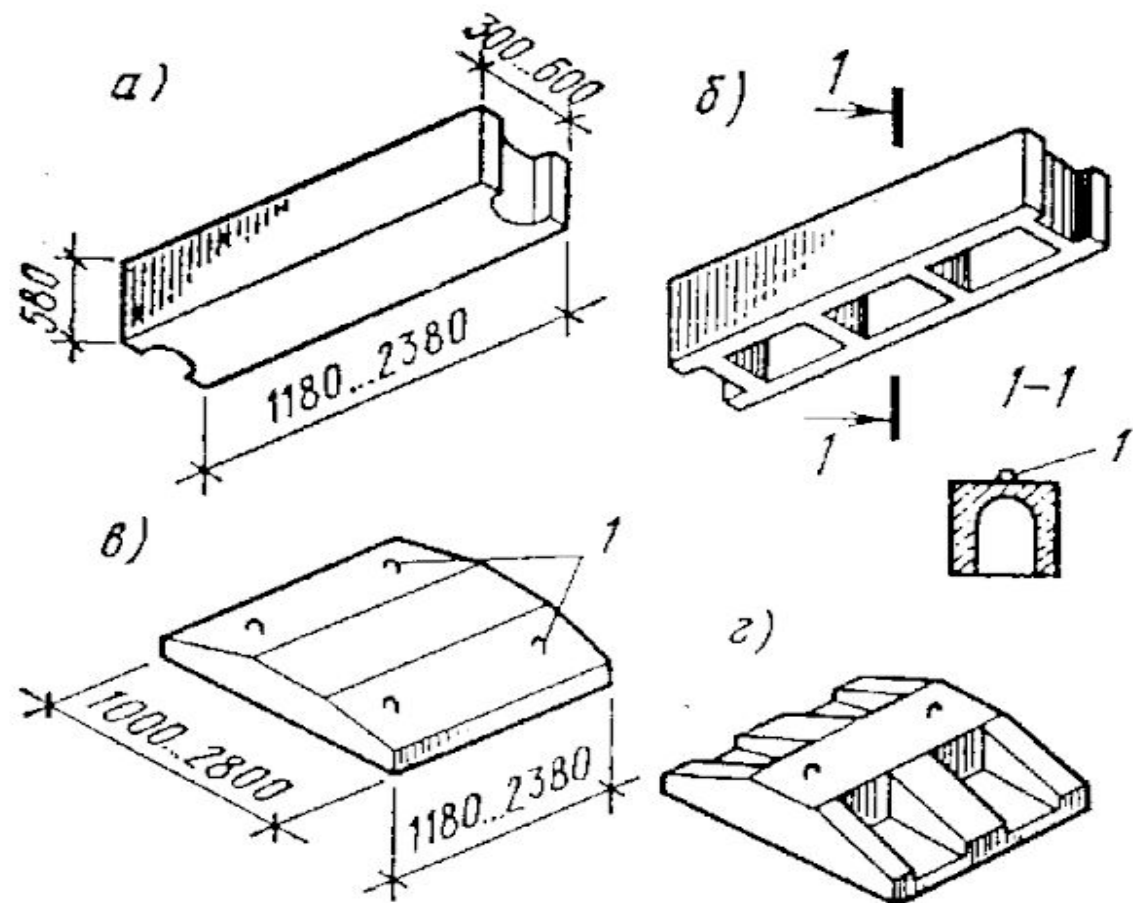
Элементы сборных бетонных и железобетонных фундаментов:
